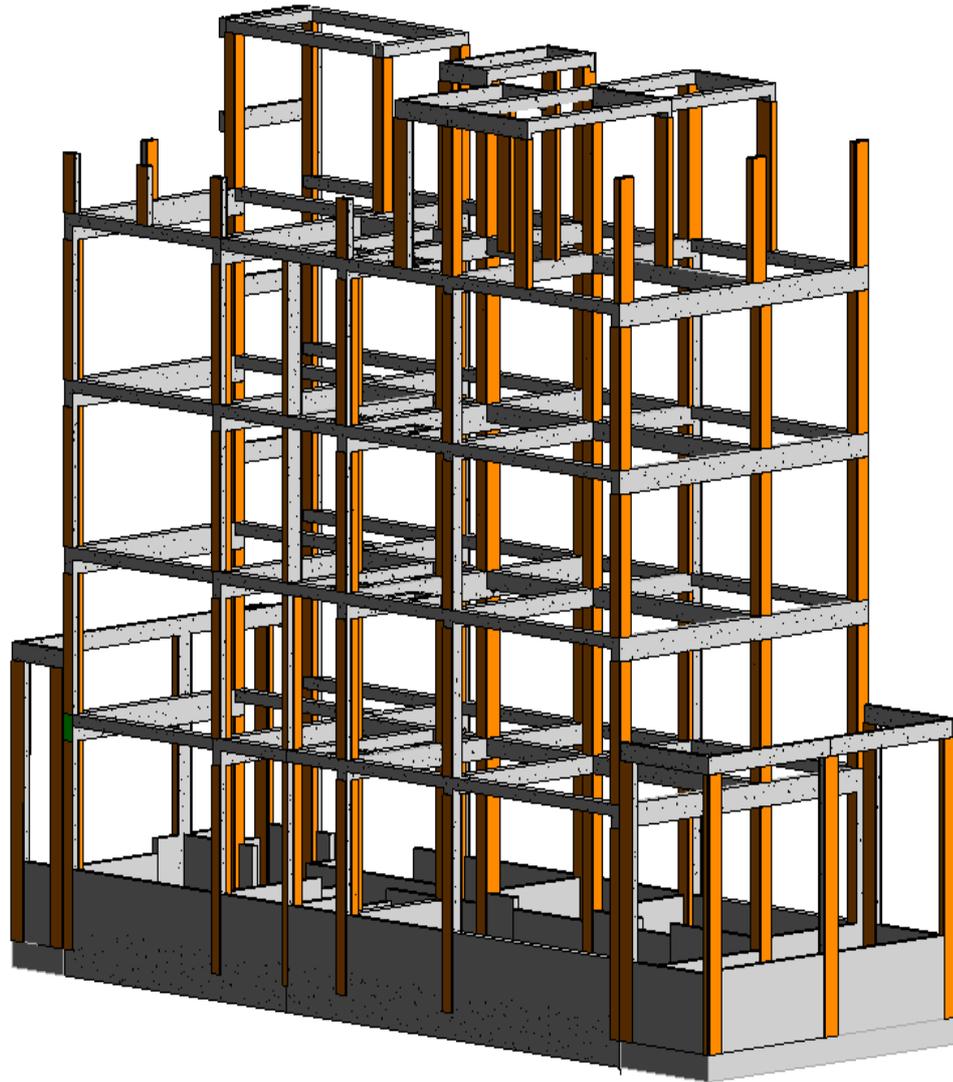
Modelo Virtual de Encofrado de Vigas de Cimentación
